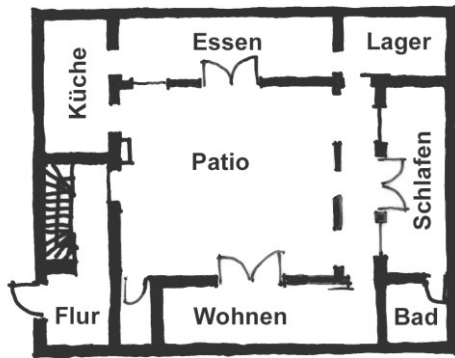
Schematischer Grundriss des Erdgeschosses eines typischen marokkanischen Stadthauses in Innenhofbauweise.
